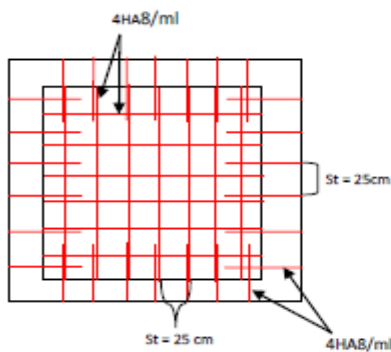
Schémas de ferrailage de la dalle au-dessous
